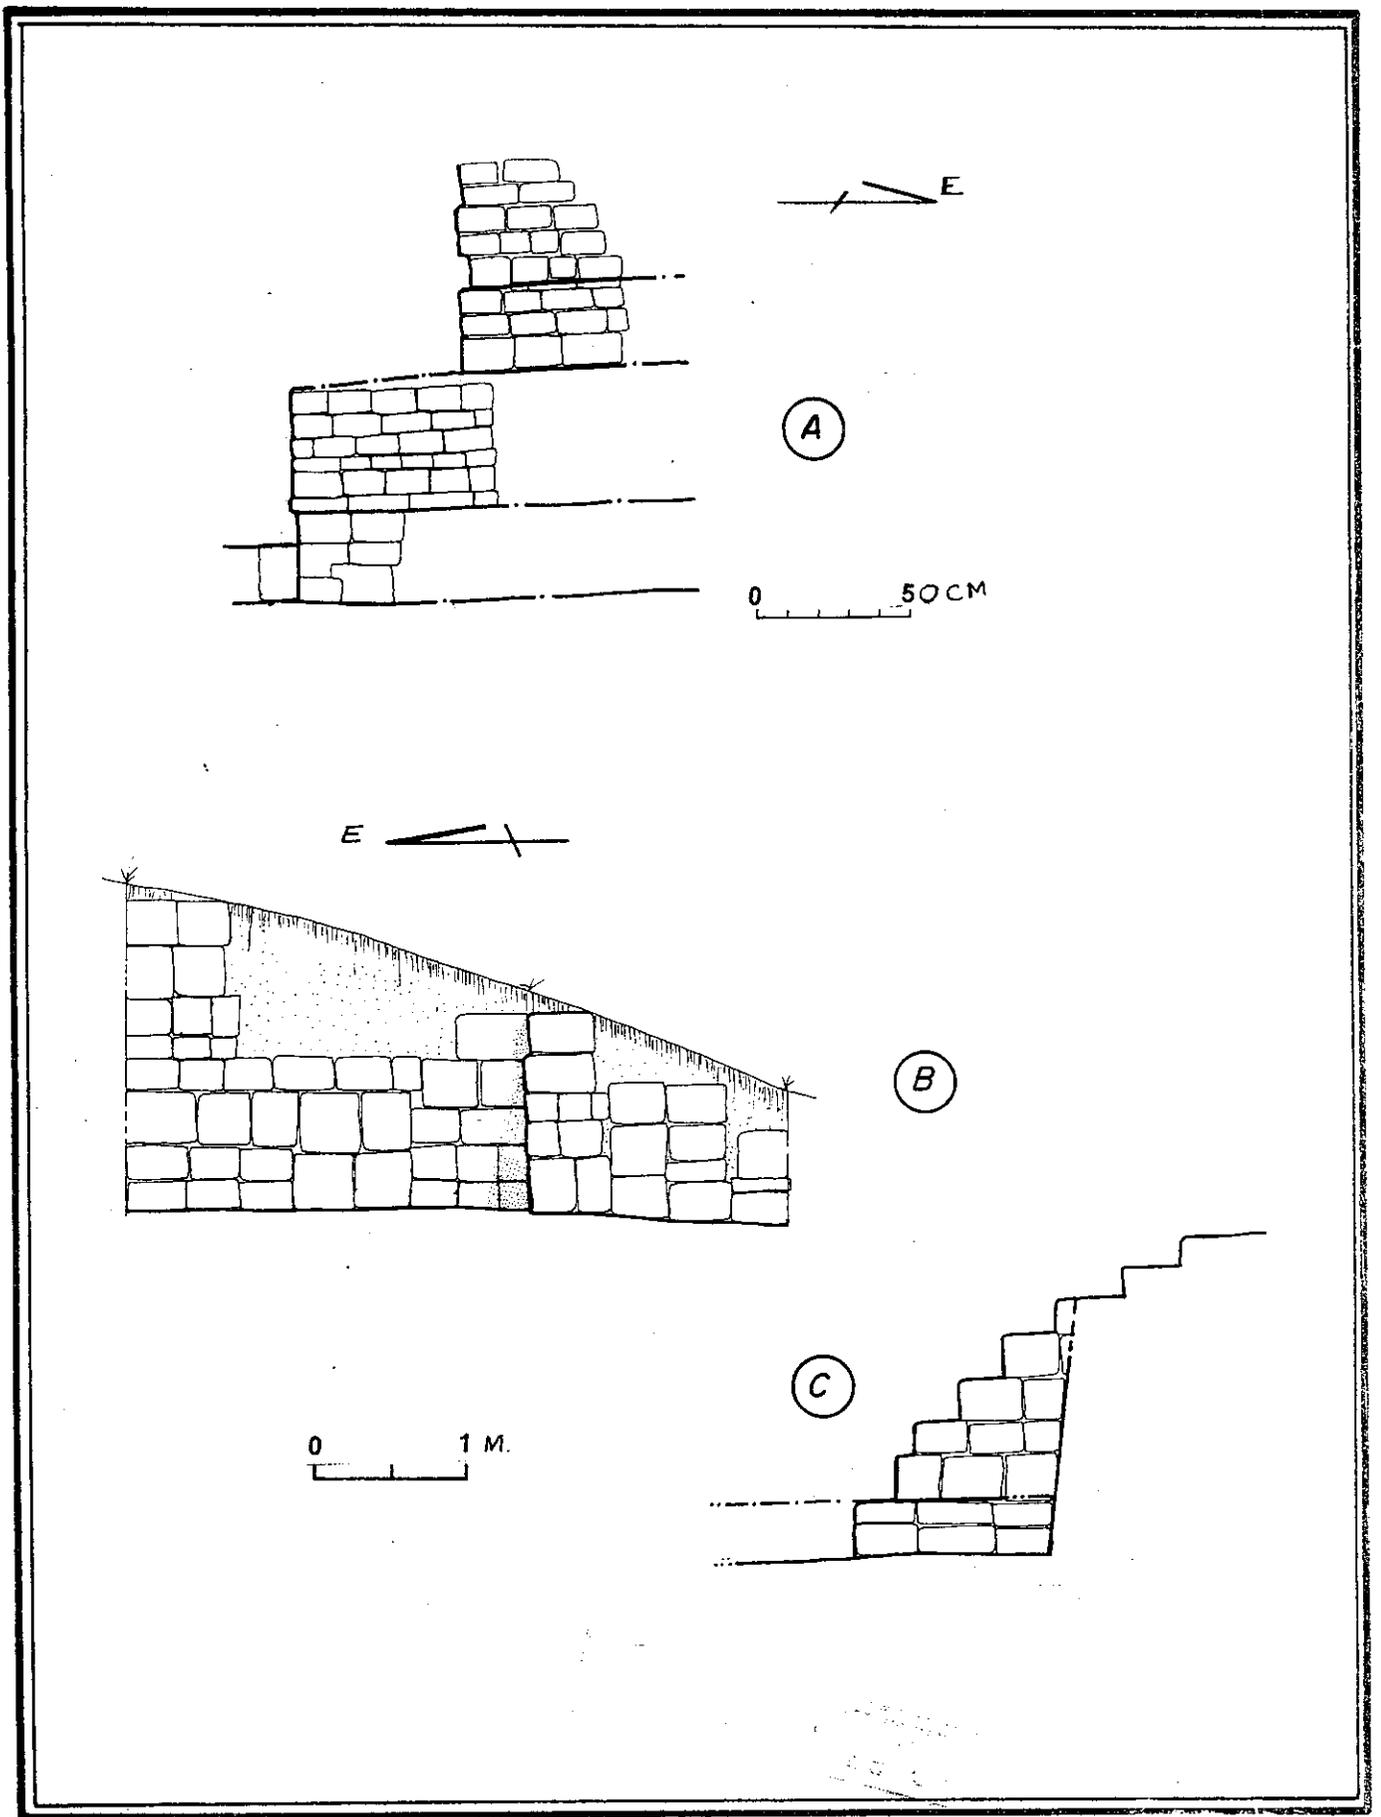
Detalles arquitectónicos de la Estructura Oeste A) Esquina suroeste, B) Muro norte, C) Escalinata
